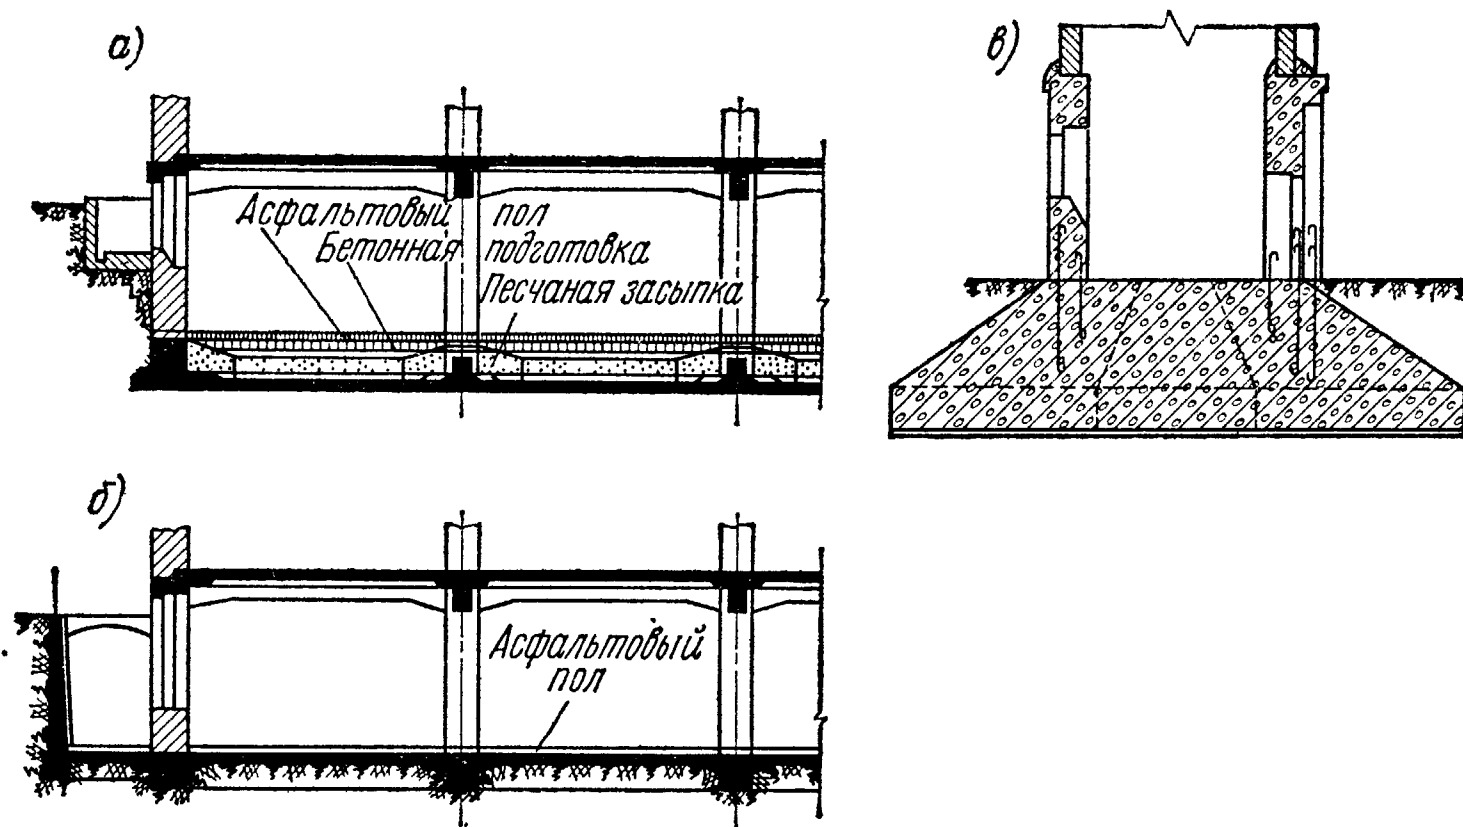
Конструкция сплошных фундаментов в различных сооружениях:
